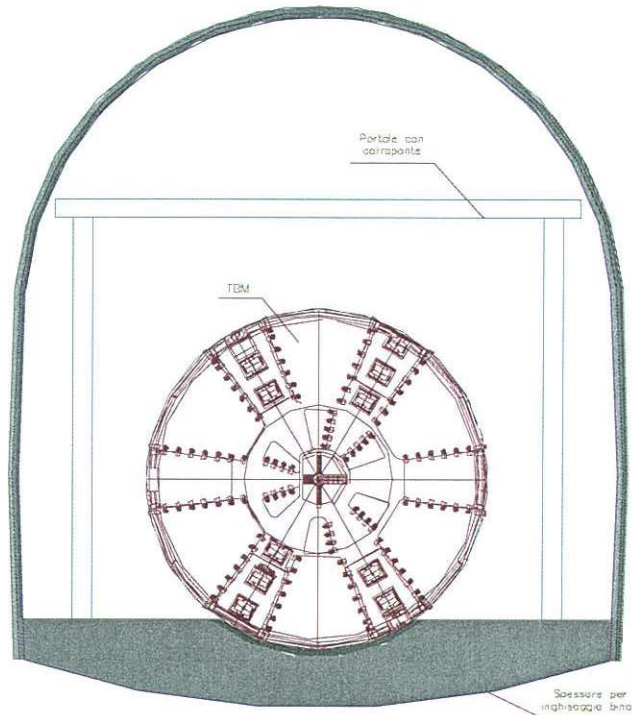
Sezione camerone di lancio TBM - fase esecutiva montaggio TBM
